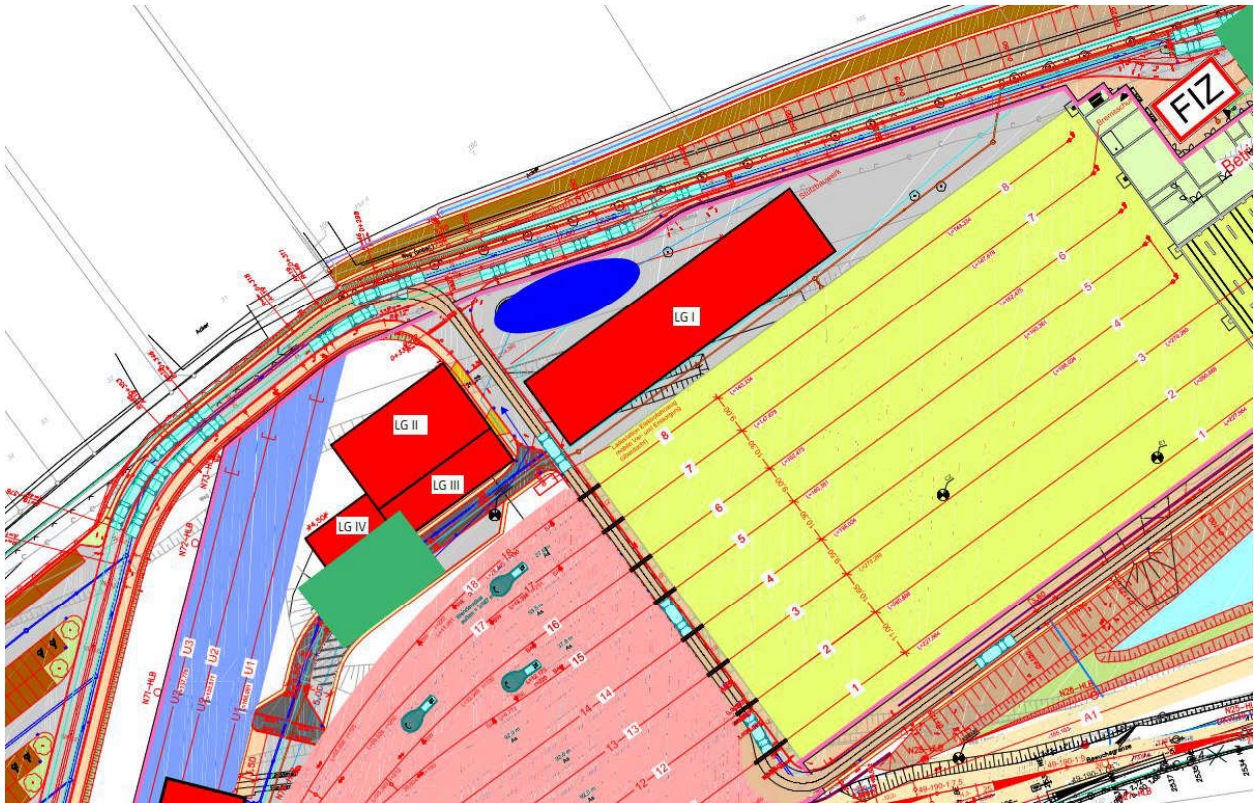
Ausschnitt aus Lageplan mit Bewegungsflächen (grün)
